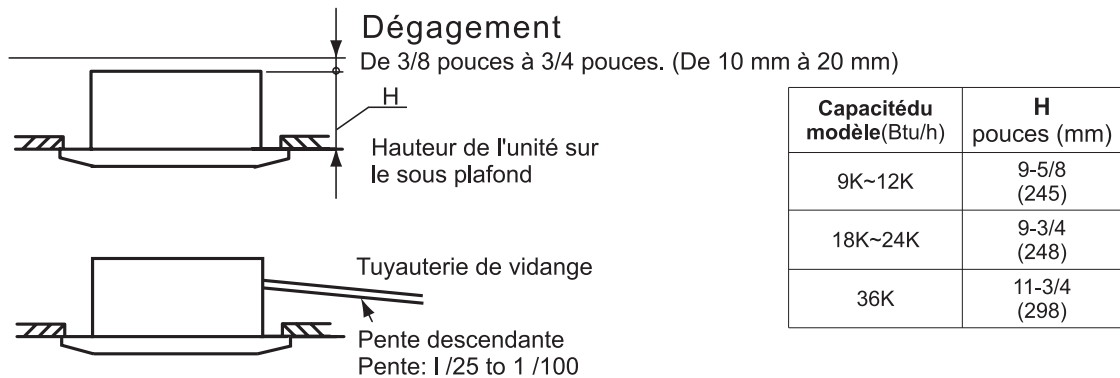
Emplacement de l'installation de l'unité intérieure
